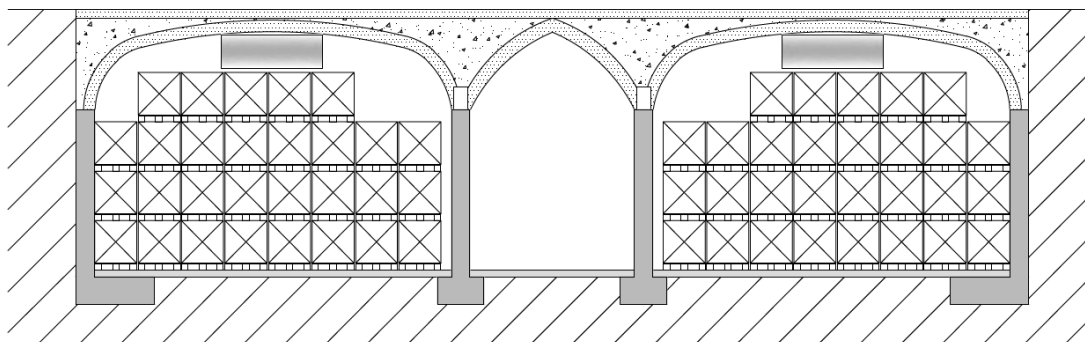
Secció lateral estreta del *Plànol 21. Proposta de distribució en la planta inferior de la nova edificació (FASE 4)*.
